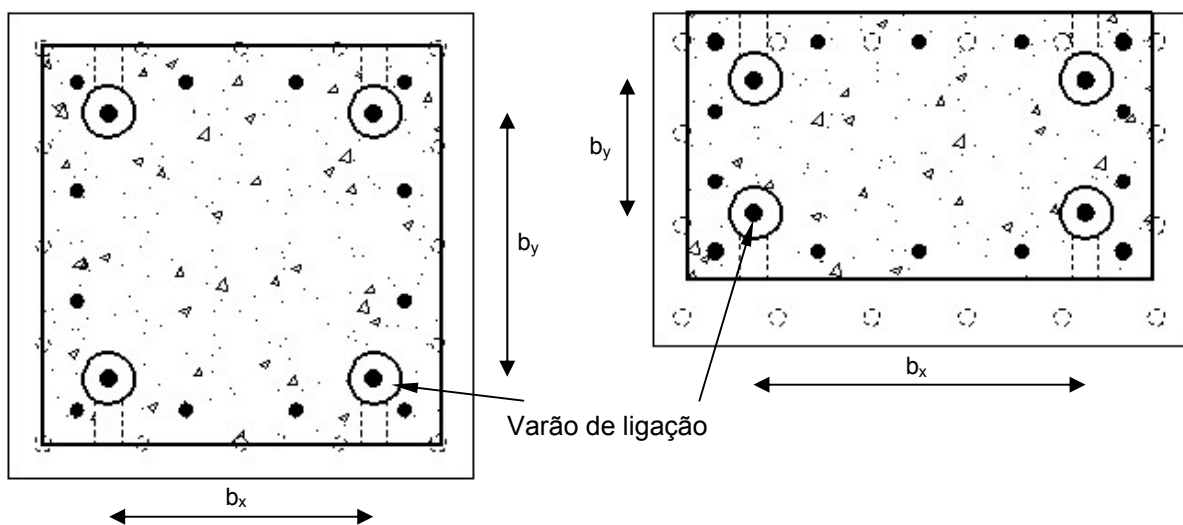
Planta tipo da ligação pilar – pilar e respectivos braços para o cálculo do M_{rd} da ligação
